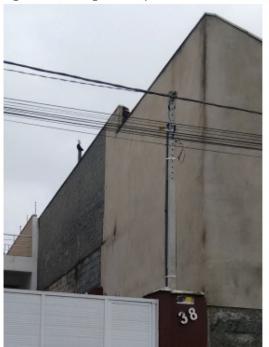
Imagem da questão sobre construção de parede cegas nas divisas do lote.
